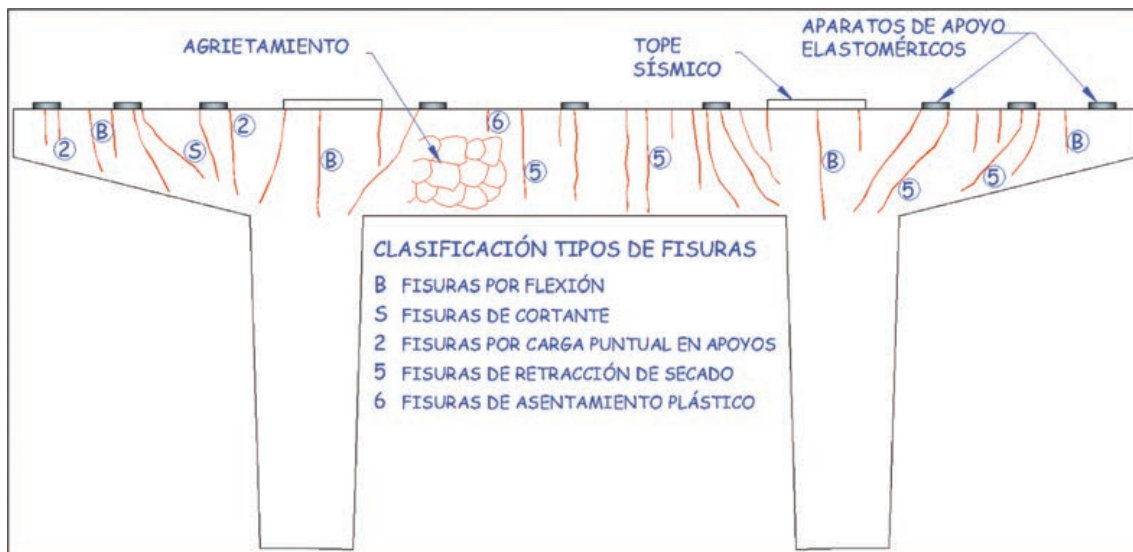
ESQUEMA DE FISURACIÓN TÍPICO EN PILAS DE HORMIGÓN ARMADO TIPO PÓRTICO.
